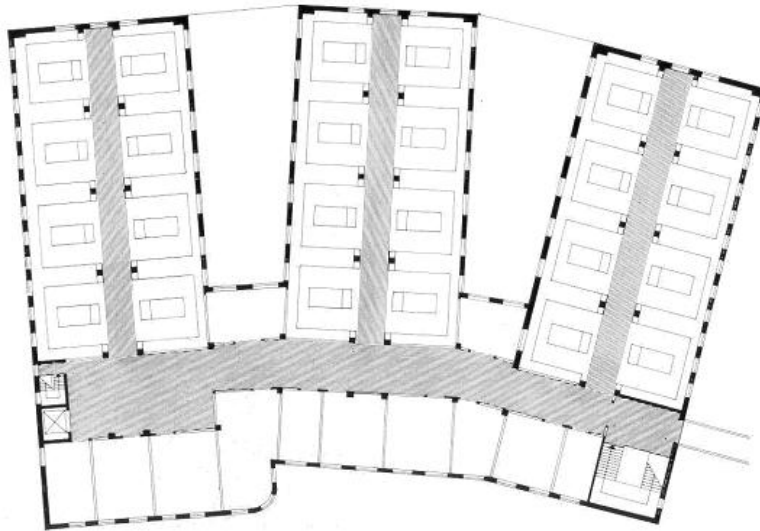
Hauptlaboratorium-Grundrisschema (sinnbildlich: Kamm mit drei Zähnen oder gespreizte Fingerform) Geb. B 02 von 1932/ 33 - Architekt: Walter Furthmann
